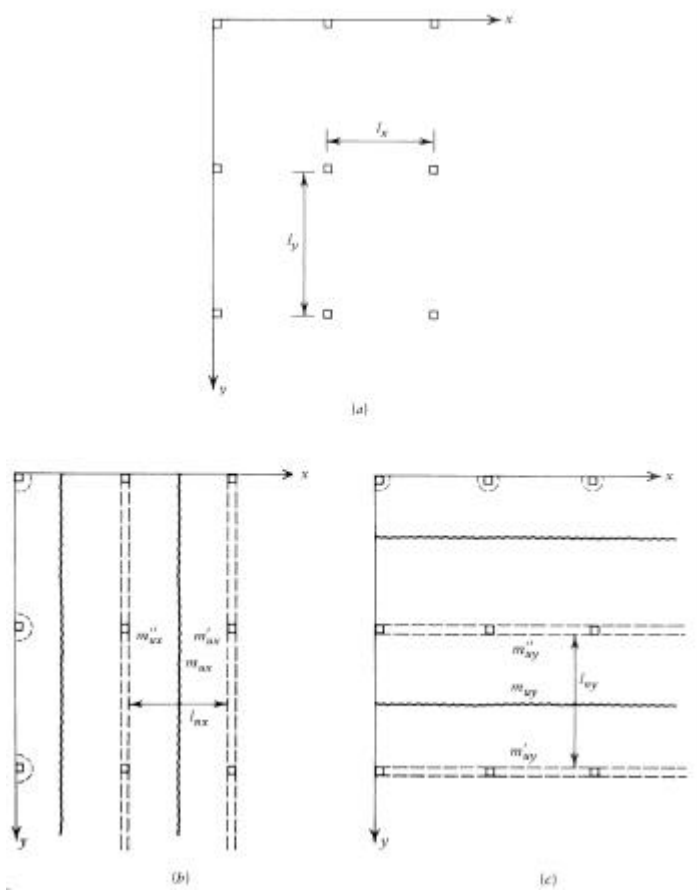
Configuración de rotura global en placas sobre apoyos aislados con carga uniforme. (a) Planta. (b) Rotura en dirección del eje y . (c) Rotura en dirección del eje x .
